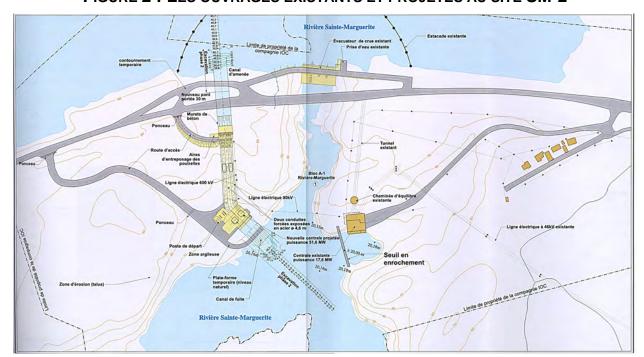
LES OUVRAGES EXISTANTS ET PROJETÉS AU SITE SM-2
